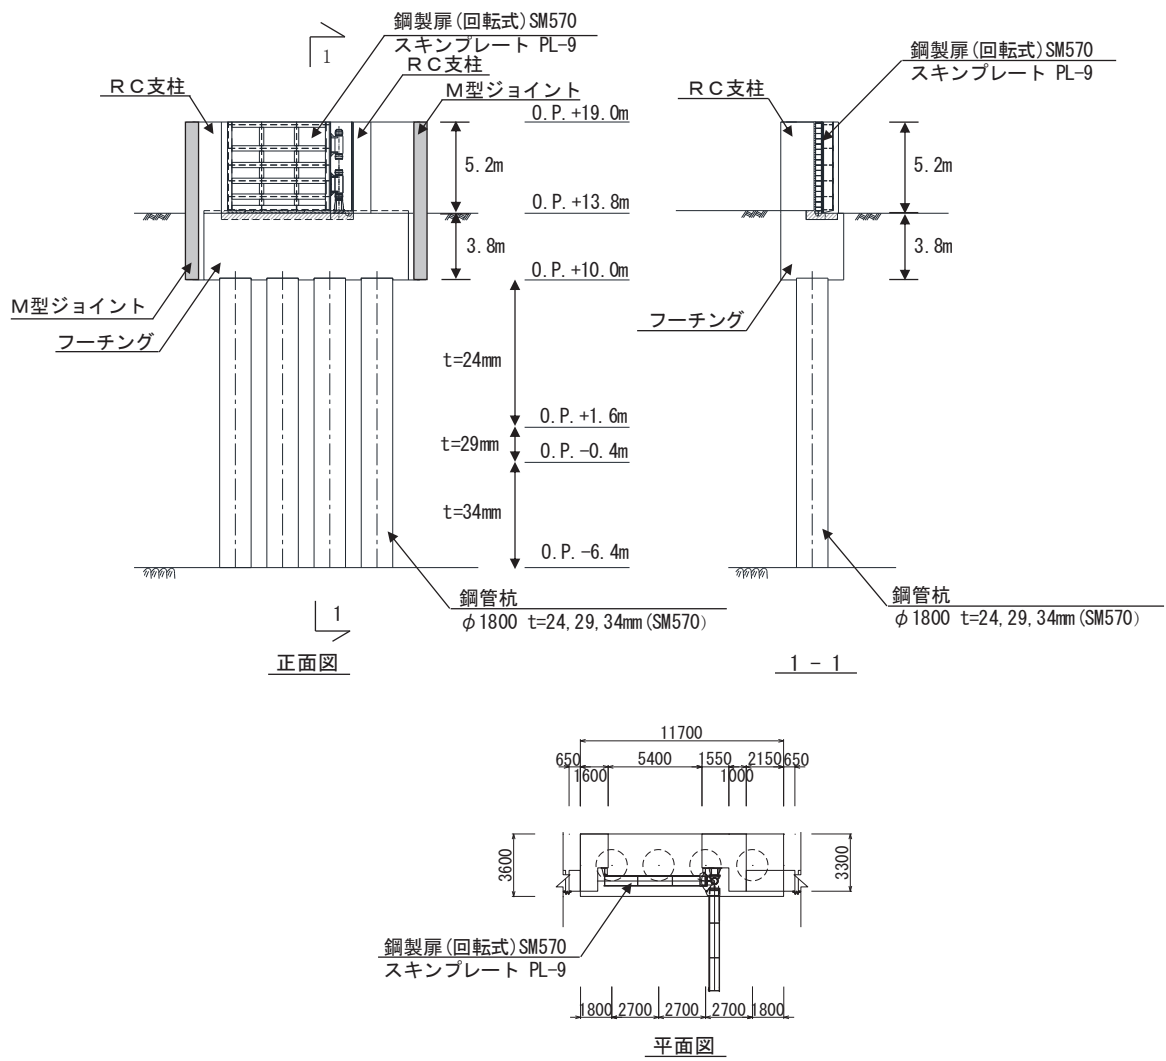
(1) 鋼製扉 4 の構造図 (正面図及び断面図, 平面図)
